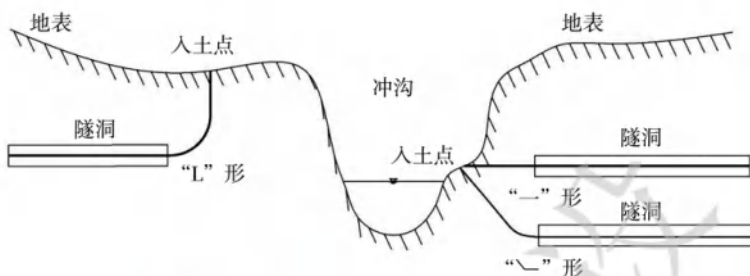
地下硐室群定向钻孔轨迹剖面示意图
